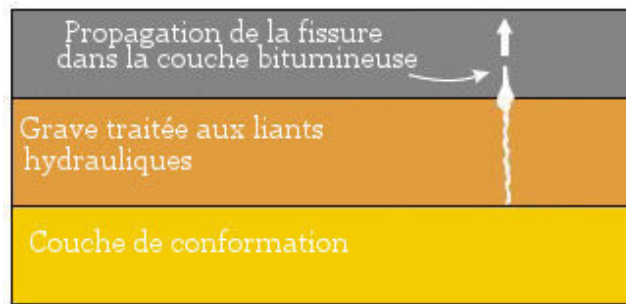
Fissuration réflexive dans une chaussée semi-rigide
